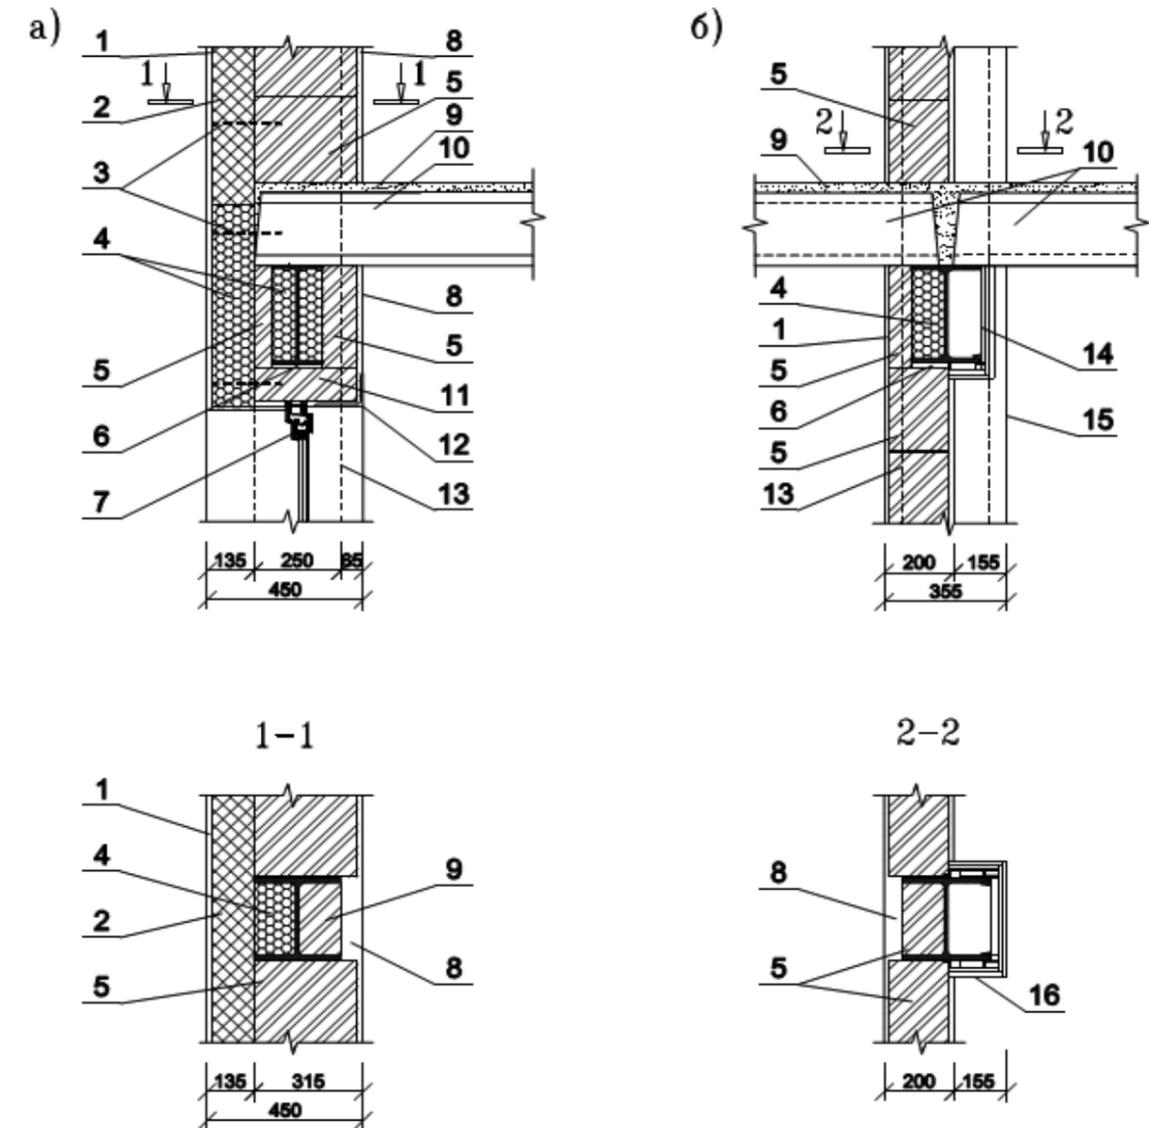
Вариант отделки и огнезащиты каркаса (сборное перекрытие):
